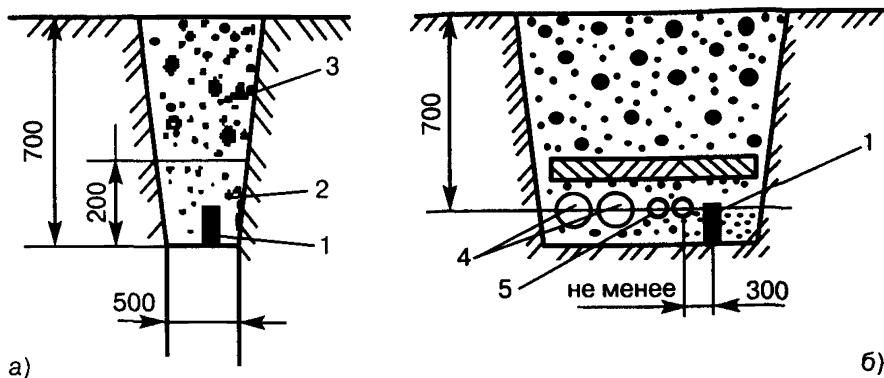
Прокладка горизонтальных заземлений в траншее (а) и совместно с кабелем (б):
